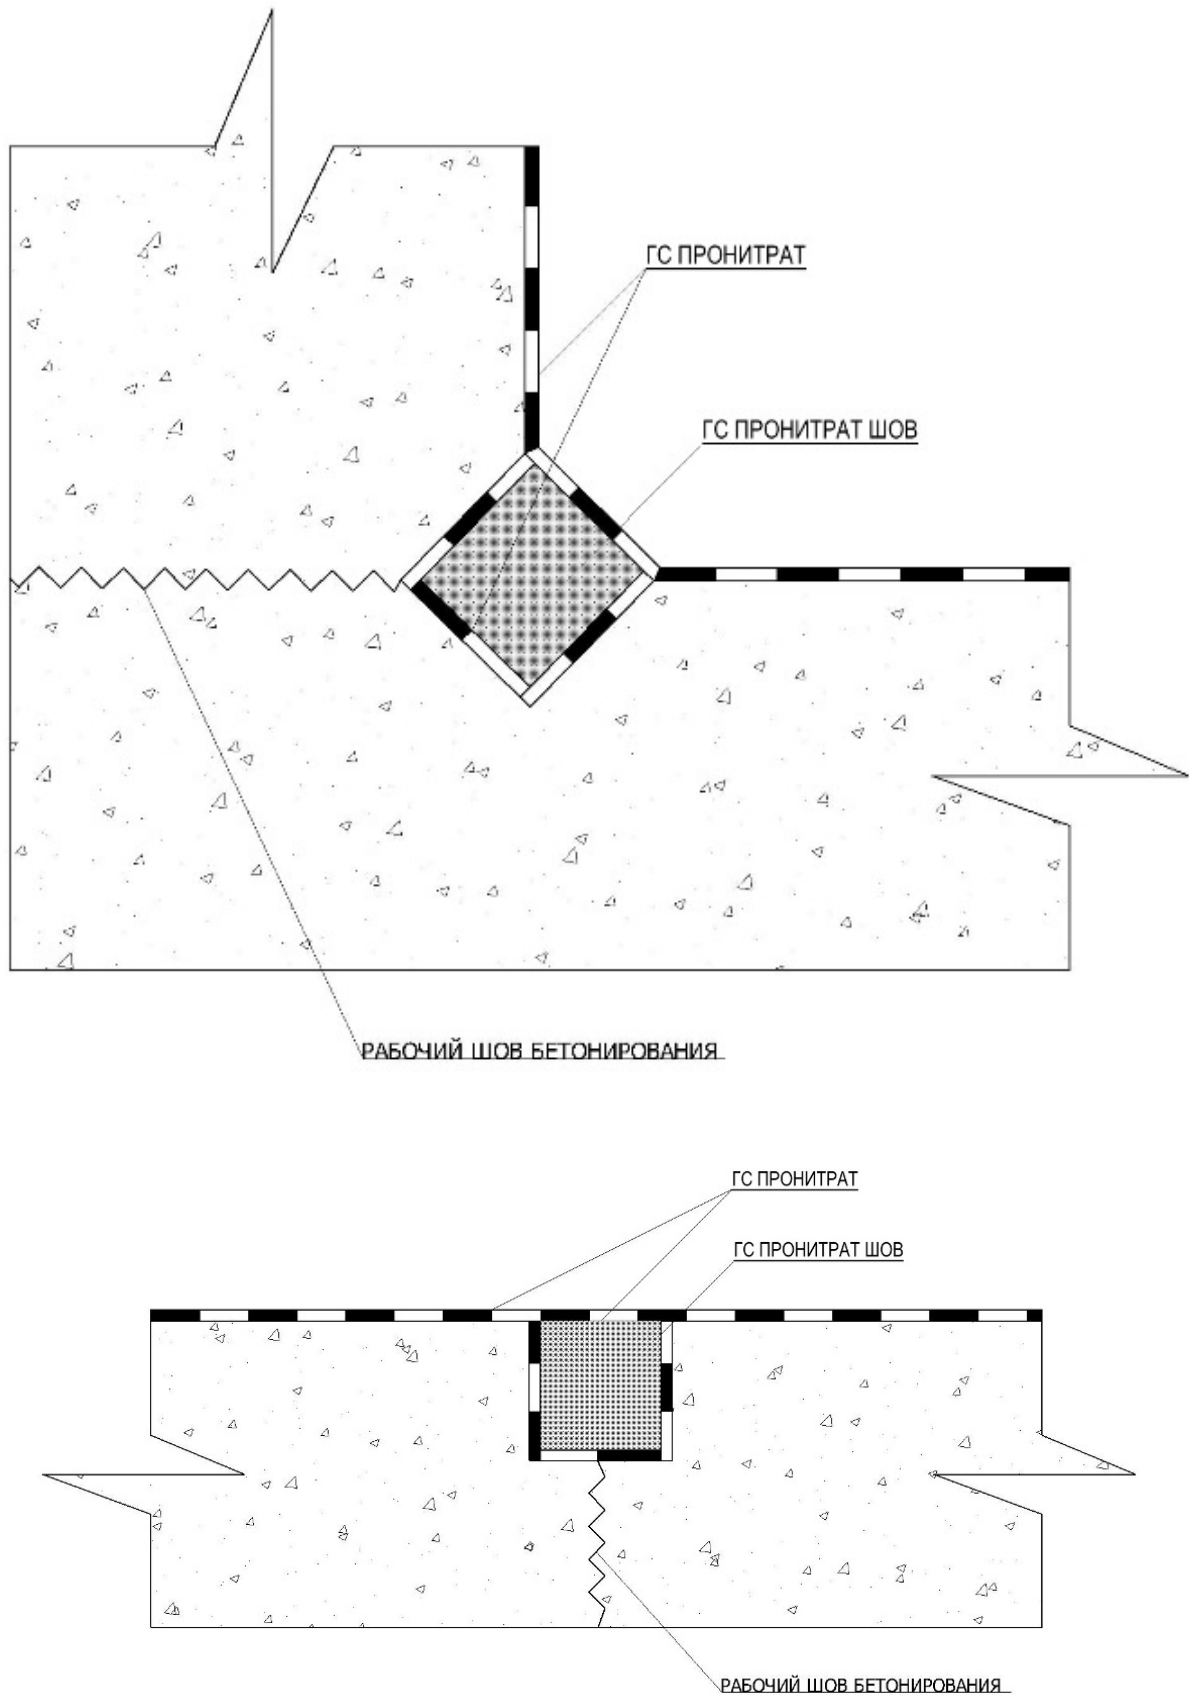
Устройство гидроизоляции рабочих швов бетонирования
